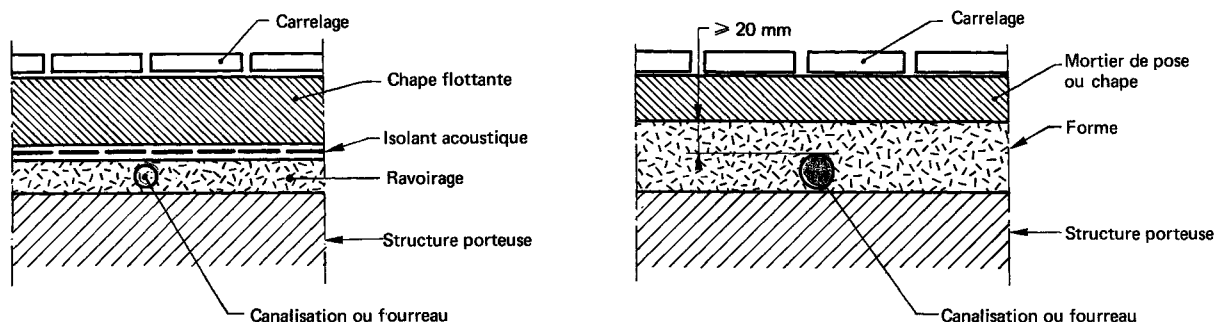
Exemples de canalisations sous carrelage - Coupes verticales
